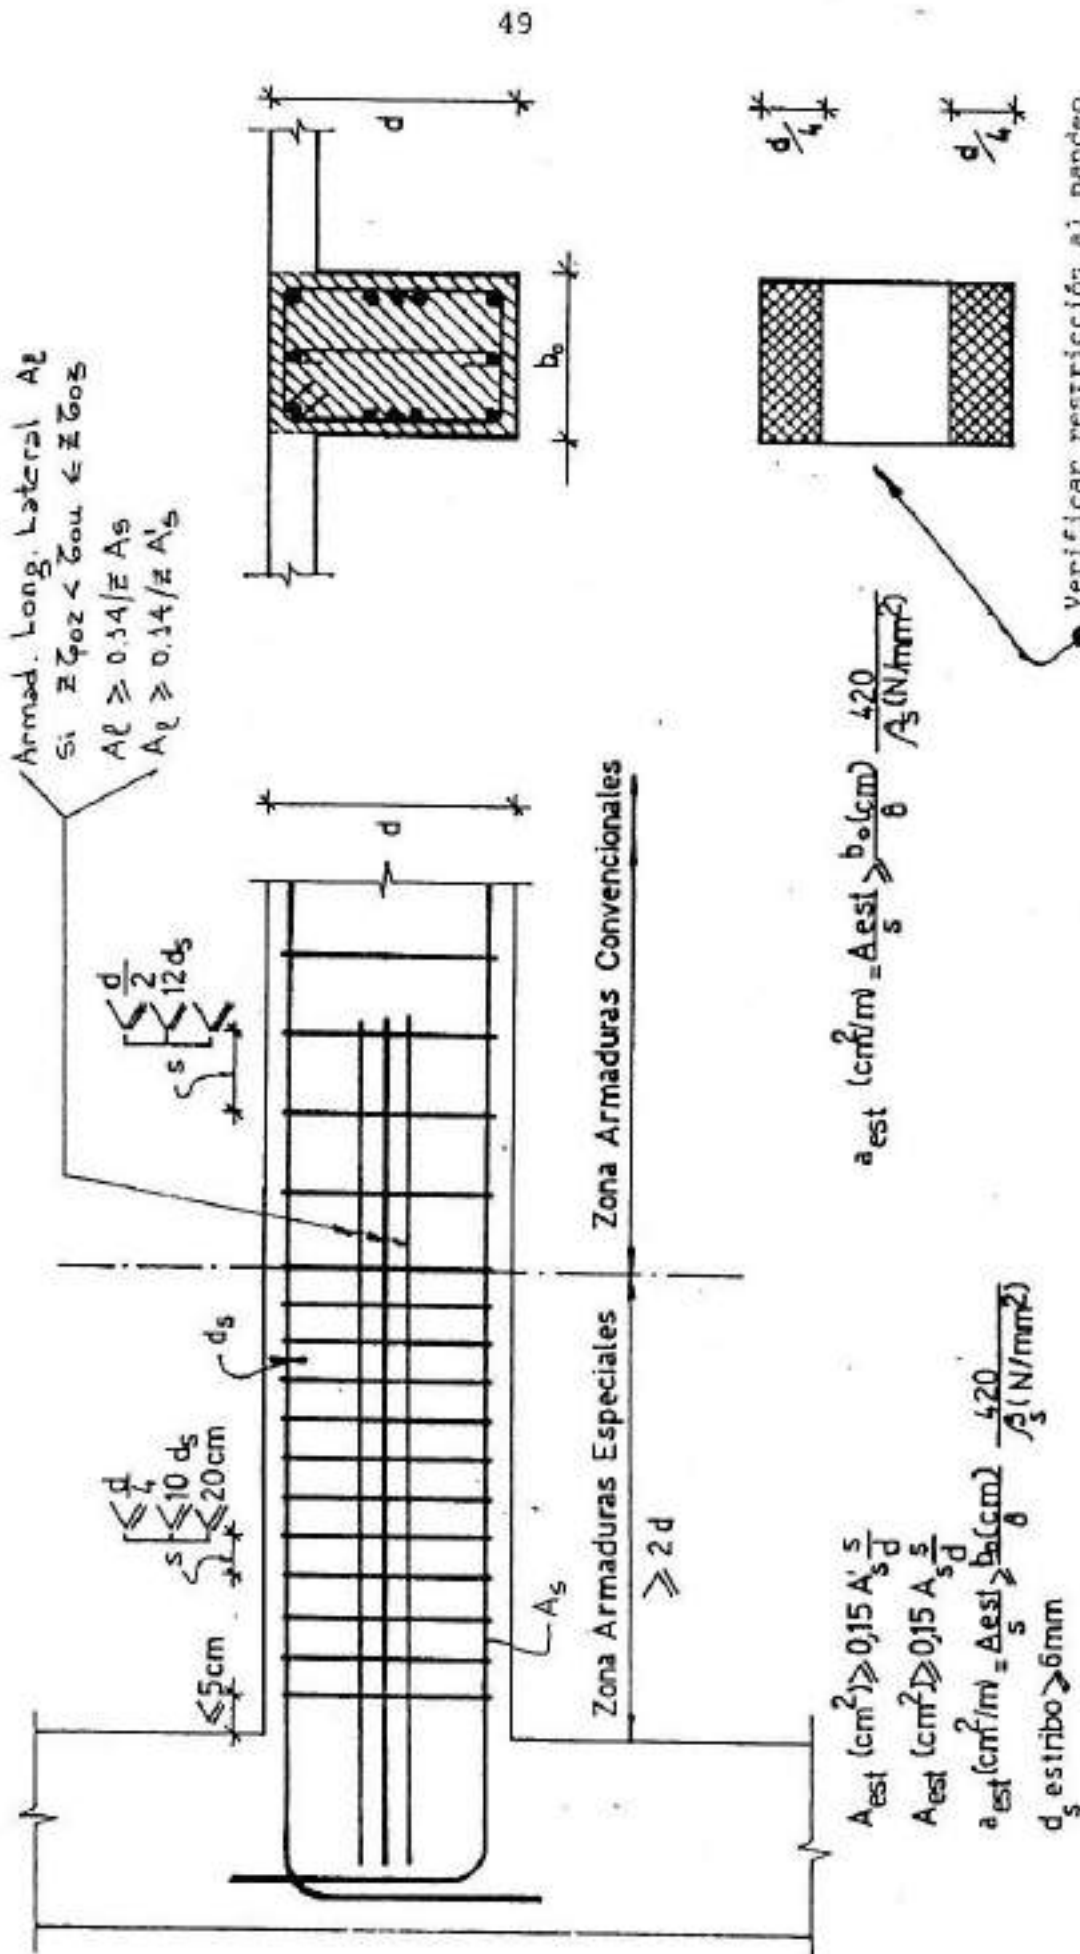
\* H.A.S.C (HORMIGON ARMADO SISMORRESISTENTE CONVENCIONAL)
